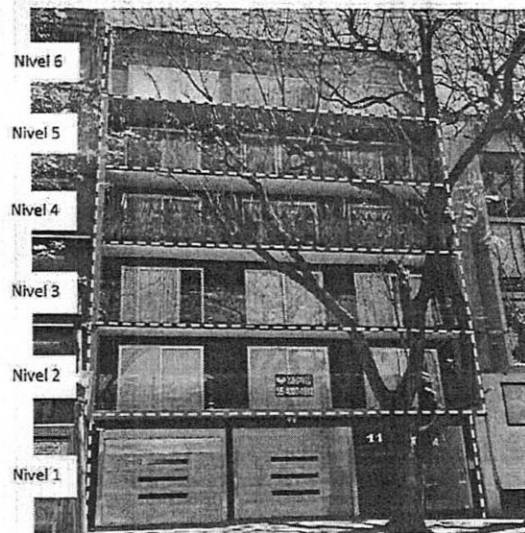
se observa un cuerpo constructivo de 6 niveles completamente edificado y parcialmente habitado
